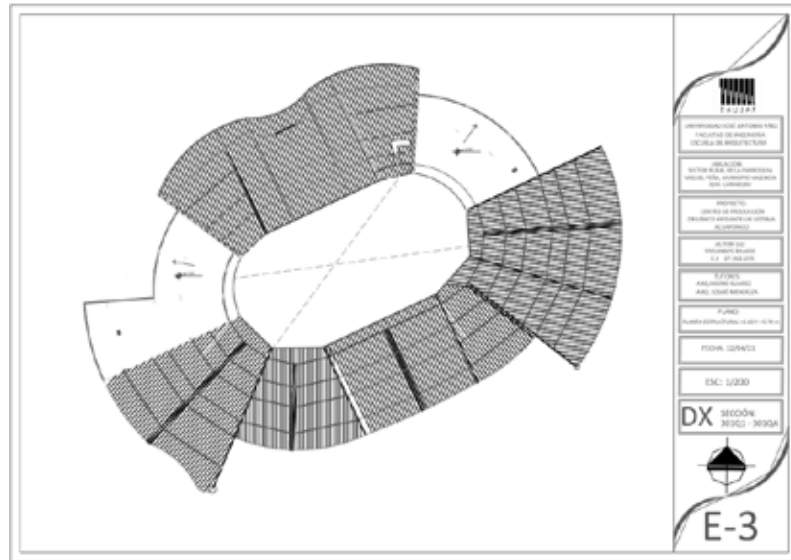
Planta Estructural + 6.00 + 5.74 m. Fuente: Presente Autora (2021)
